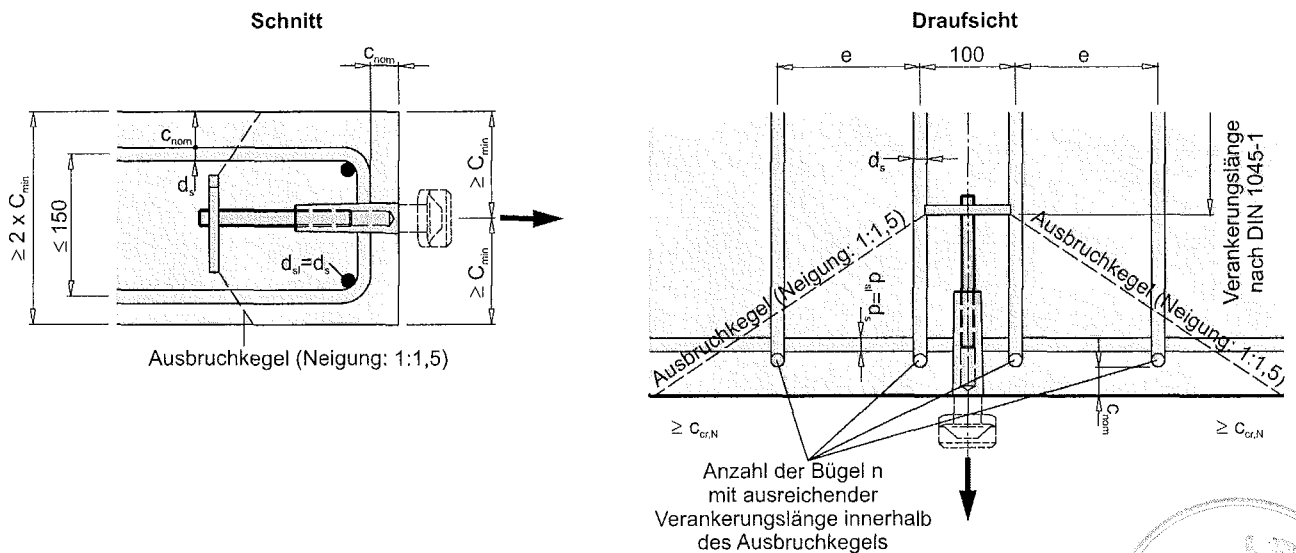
Einbausituation Stirnseite - Zugbeanspruchung mit Rückhängebewehrung - Bewehrungslage
